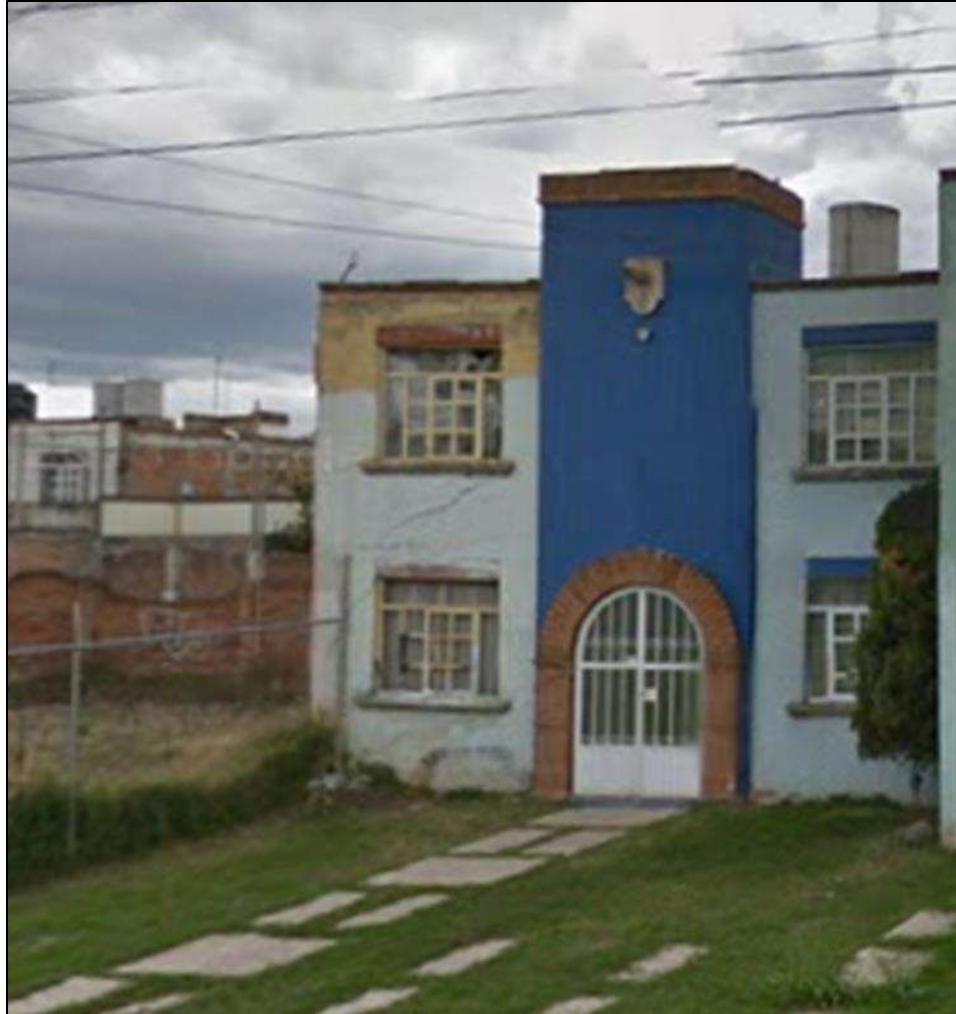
Infonavit Los Manantiales vivienda afectada por las fallas geológicas en la zona de estudio.
